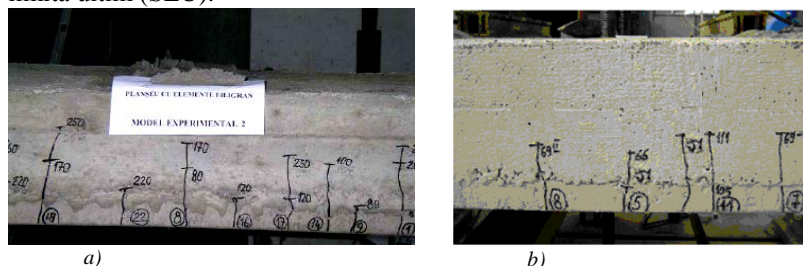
Grinzile din beton simplu (a) și armat cu fibre lungi (b), încercate la fisurare la SLS cu strat de acoperire cu beton de 50 mm
